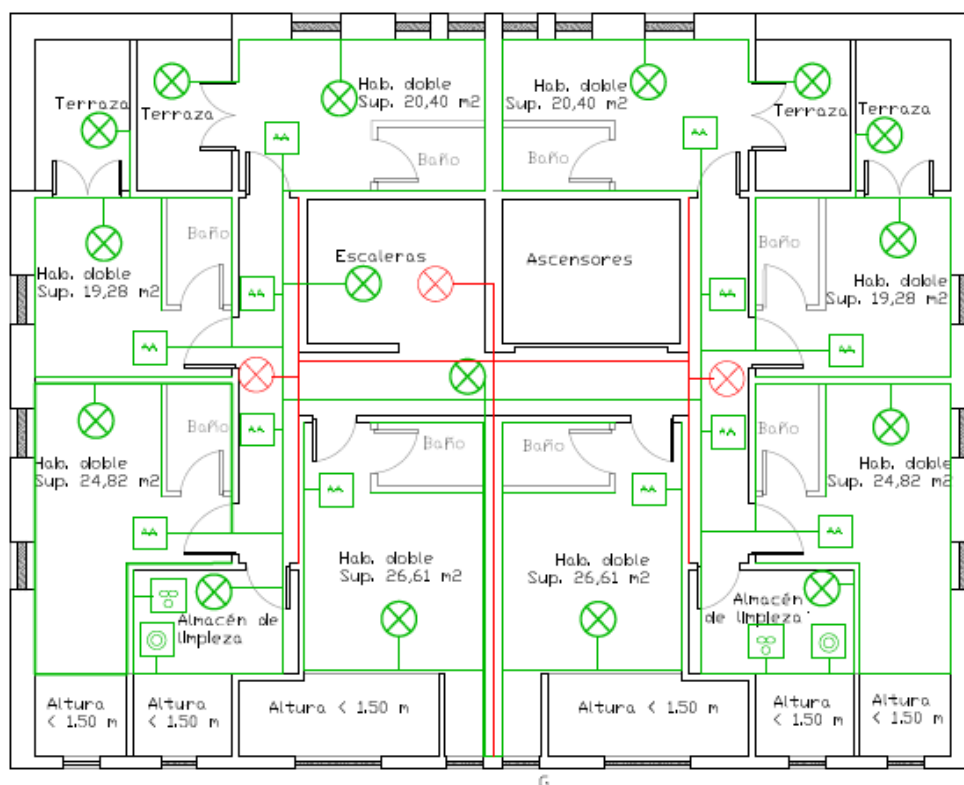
Plano del sistema eléctrico en la segunda planta. Fuente: Elaboración propia
